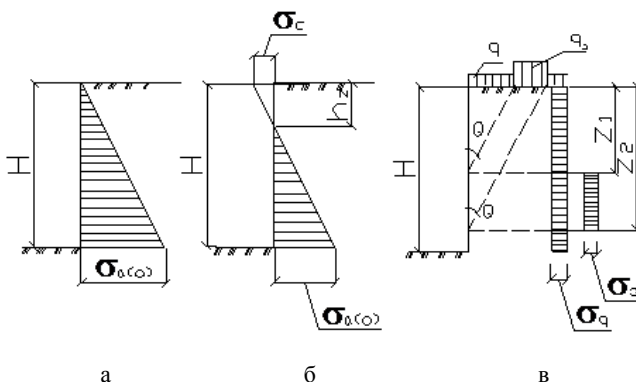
Схемы к определению давления грунта на ограждение котлована:
